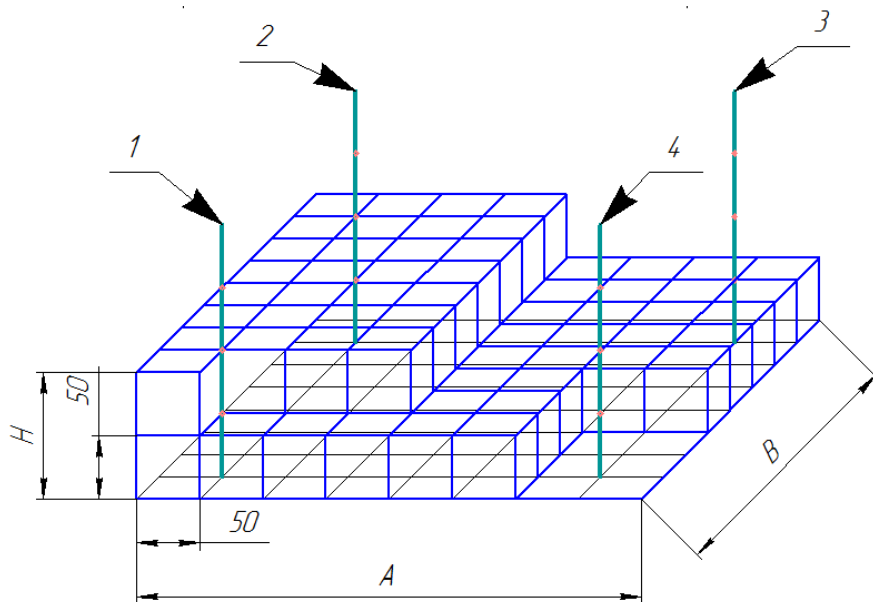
Формирование рабочей арматуры стержневыми конечными элементами
